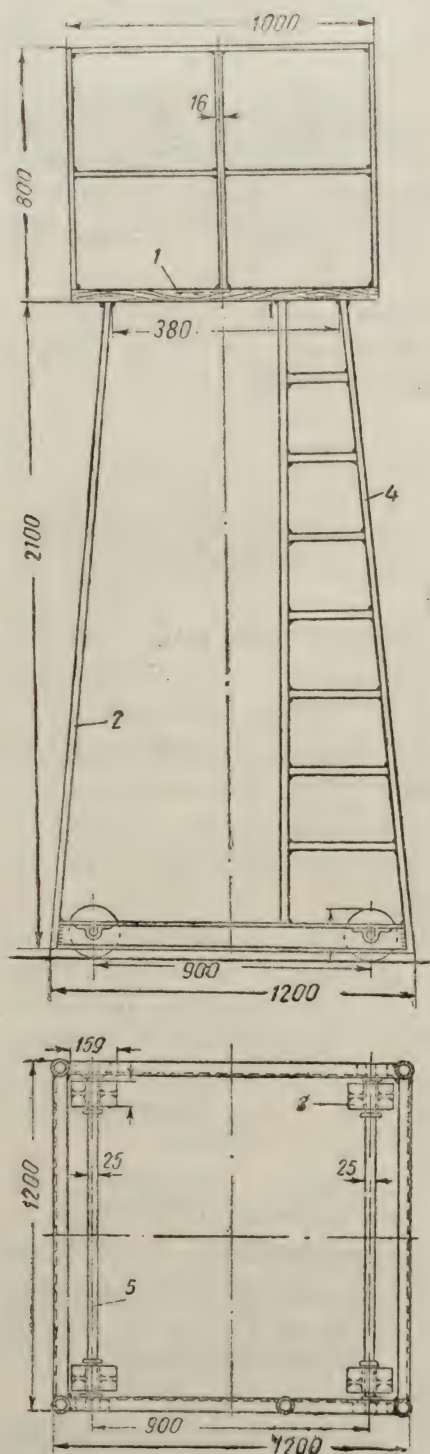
Передвижные подмости для монтажа трубопроводов и подвесных путей:
